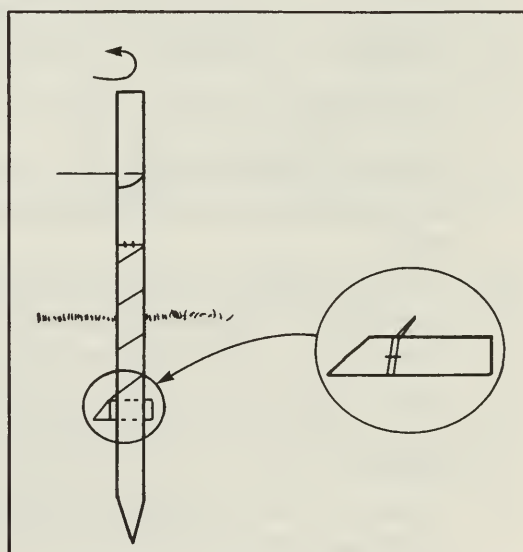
Tirant d'ancrage pour empêcher la rotation excessive d'un poteau d'extrémité.
